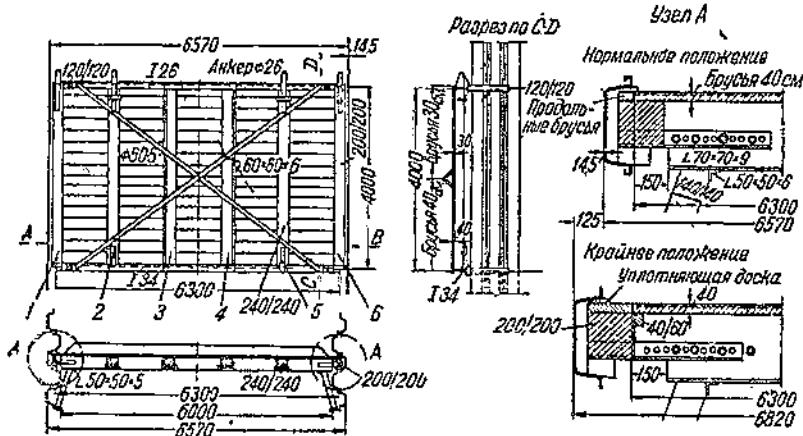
Опалубка фундаментной плиты мола в виде цельного щита.
